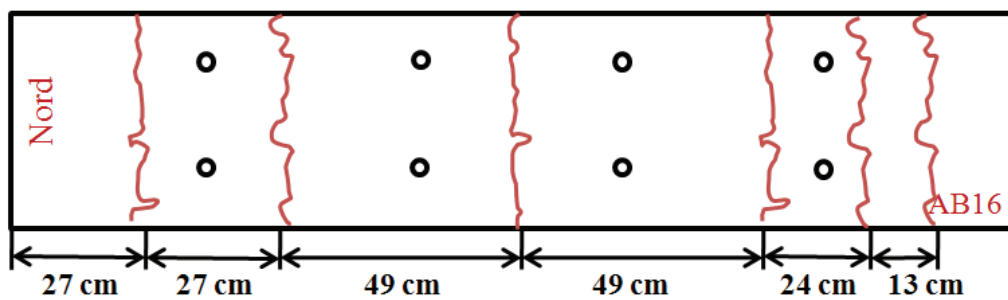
Relevé des fissures sur la poutre AB16
